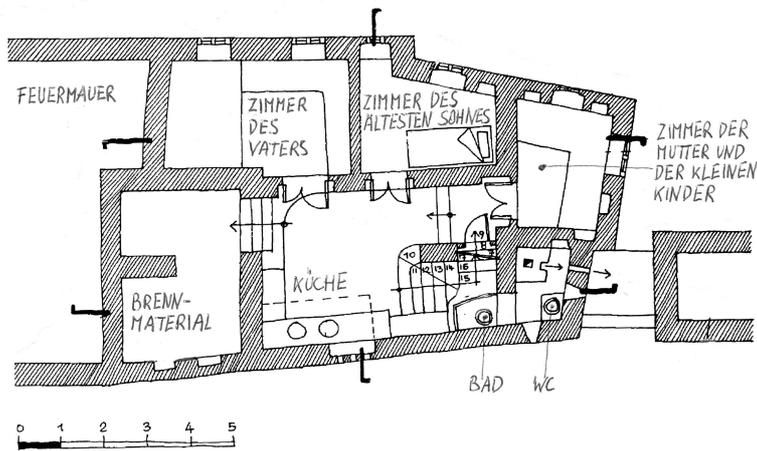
Grundriss des ersten Stockwerks des Hauses
